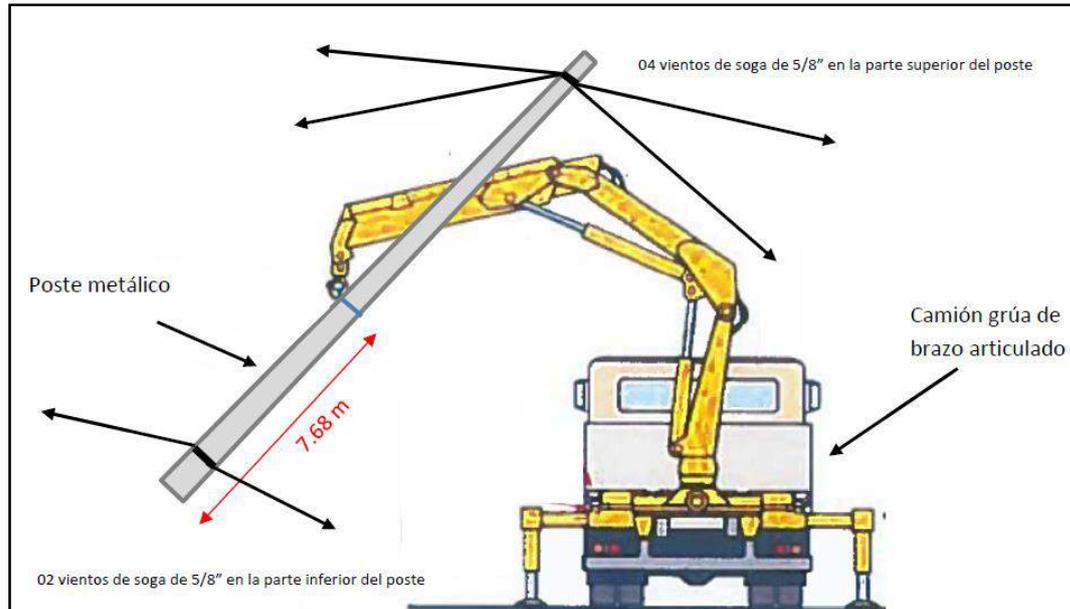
Izaje de Poste Metálico (Imagen Referencial)
